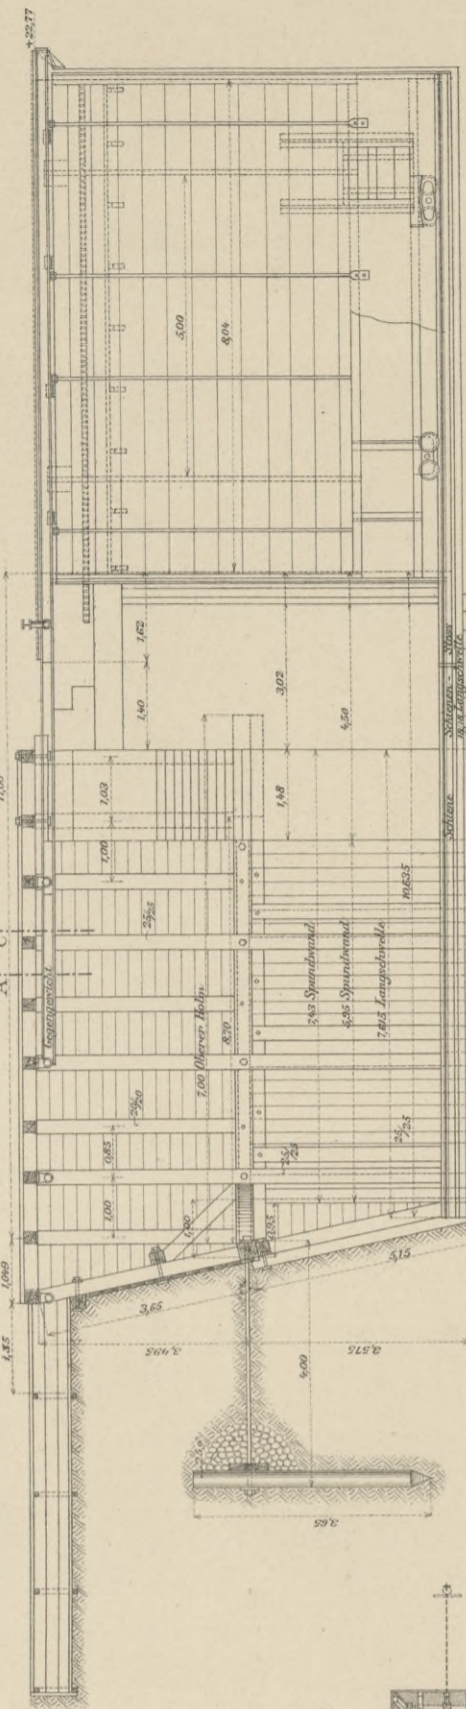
Grundriss der Schiebethorschleuse. 1:300.
